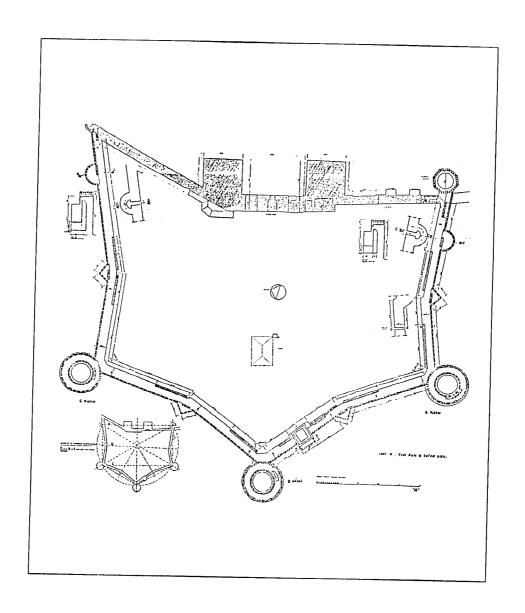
مسقط أفقي لروملي حصار بإستانبول (عن :ايفردى) .
